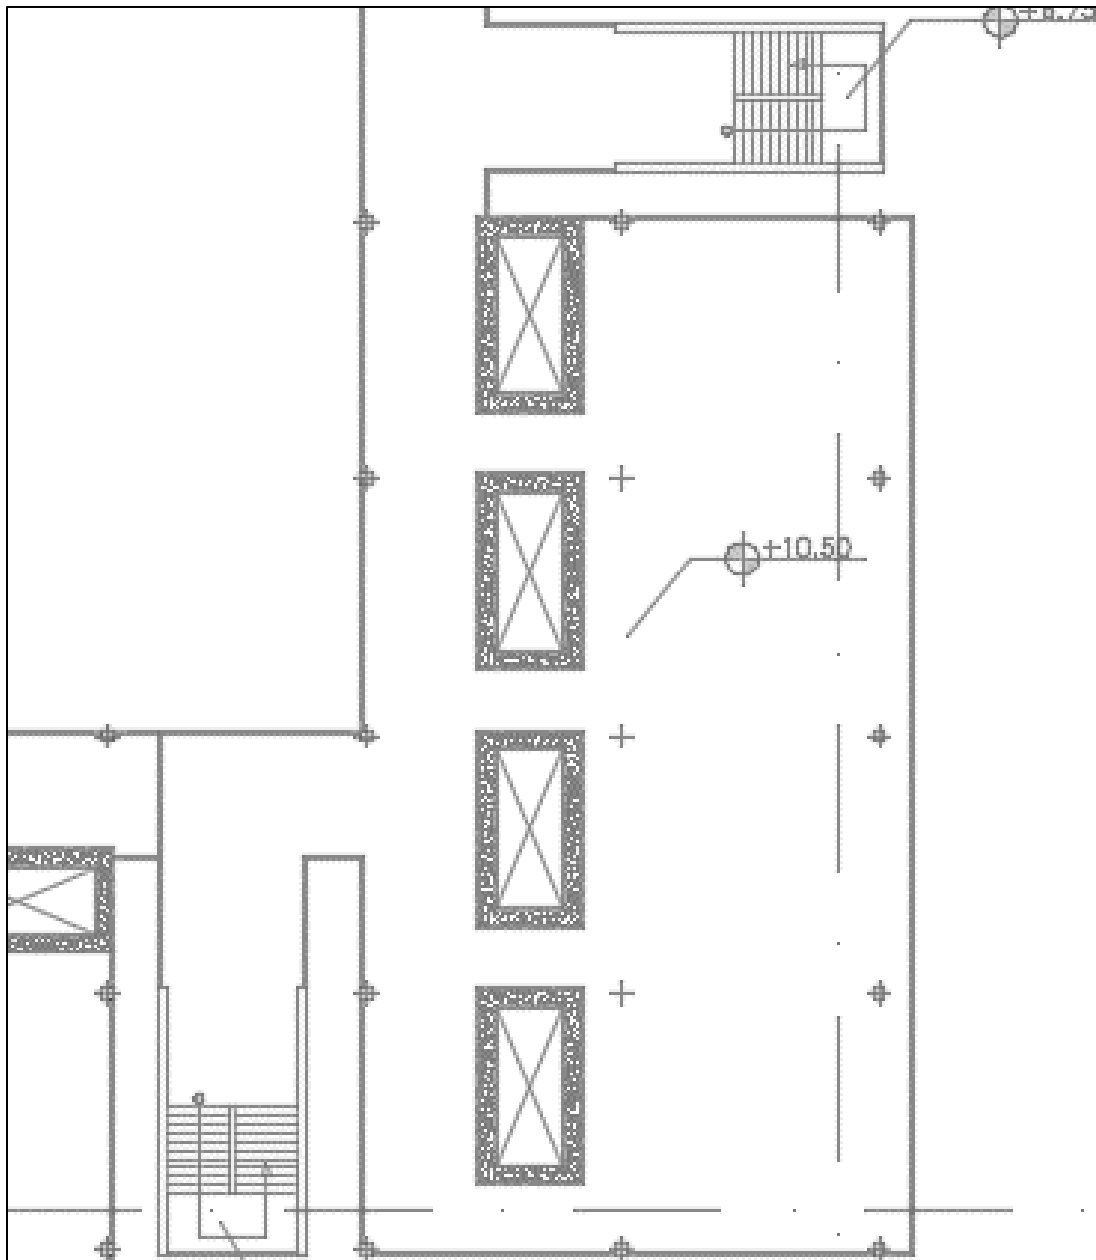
Planta Tipo Módulo Musical. Fuente: Propia autoría. (2018).
